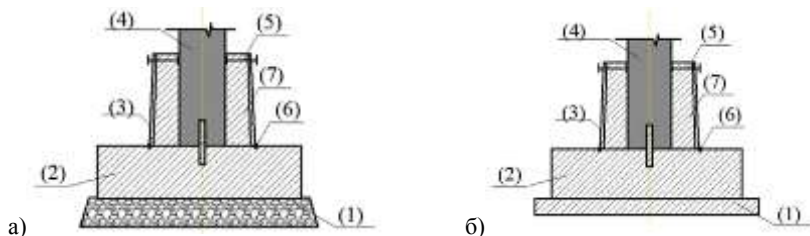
Схема влаштування фундаменту із кондуктором-опалубкою для монолітного стакану:
